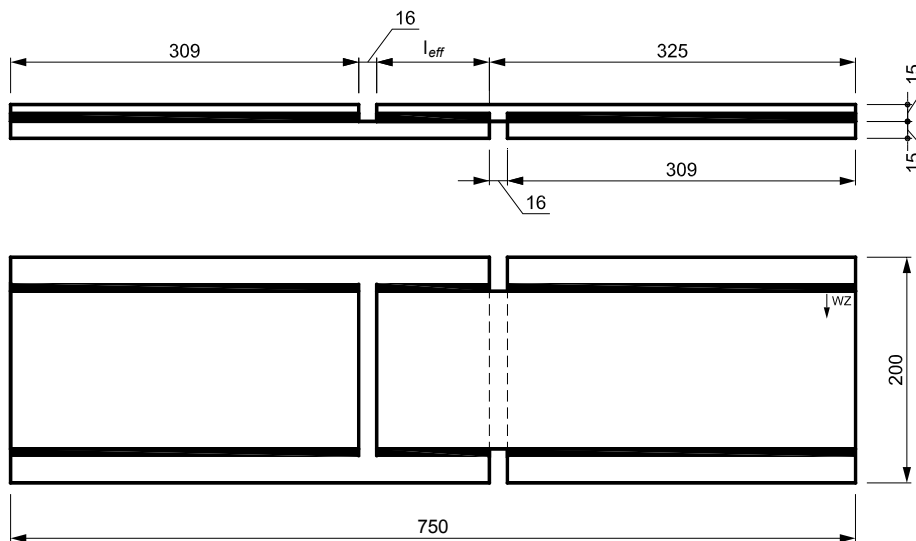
Mechanische Bearbeitung des Versuchskörpers
